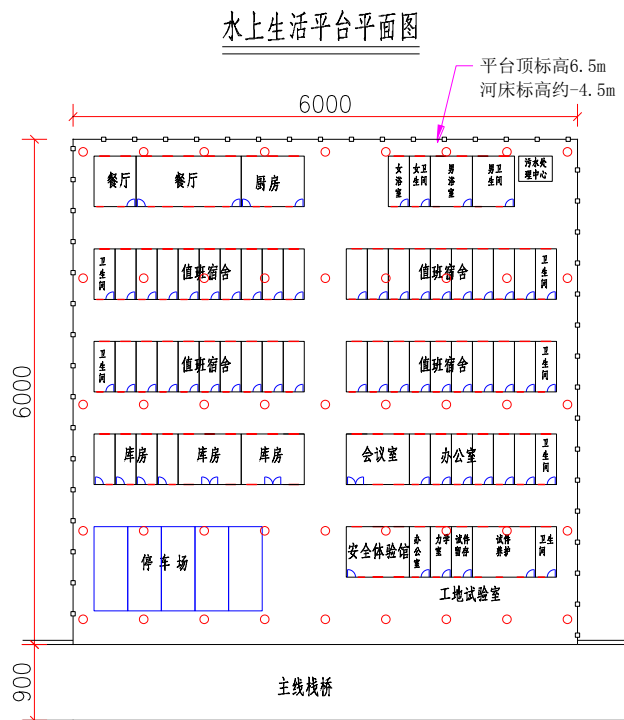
水上生活及办公平台平面布置图 (尺寸单位: cm)
